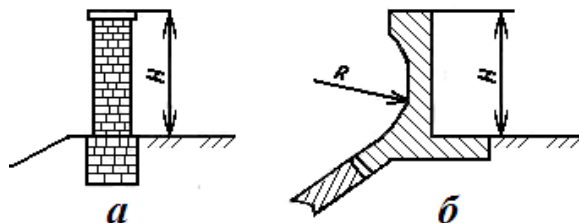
Конструктивные схемы парапетов на гребне плотины: а - из кладки; б - бетонный парапет
